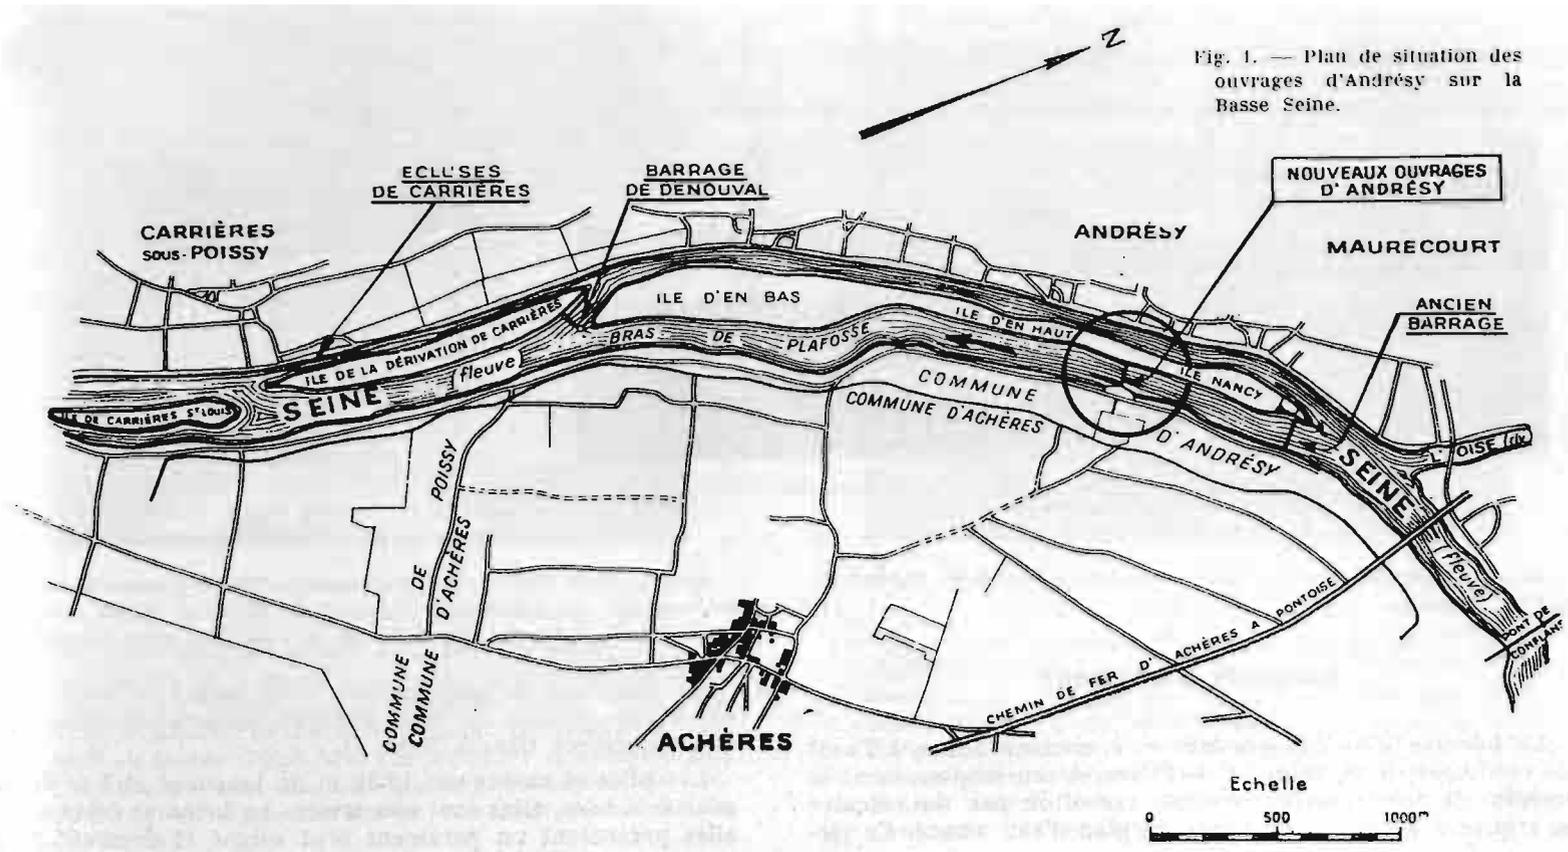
Plan de situation des ouvrages d'Andrézy sur la Basse Seine.
